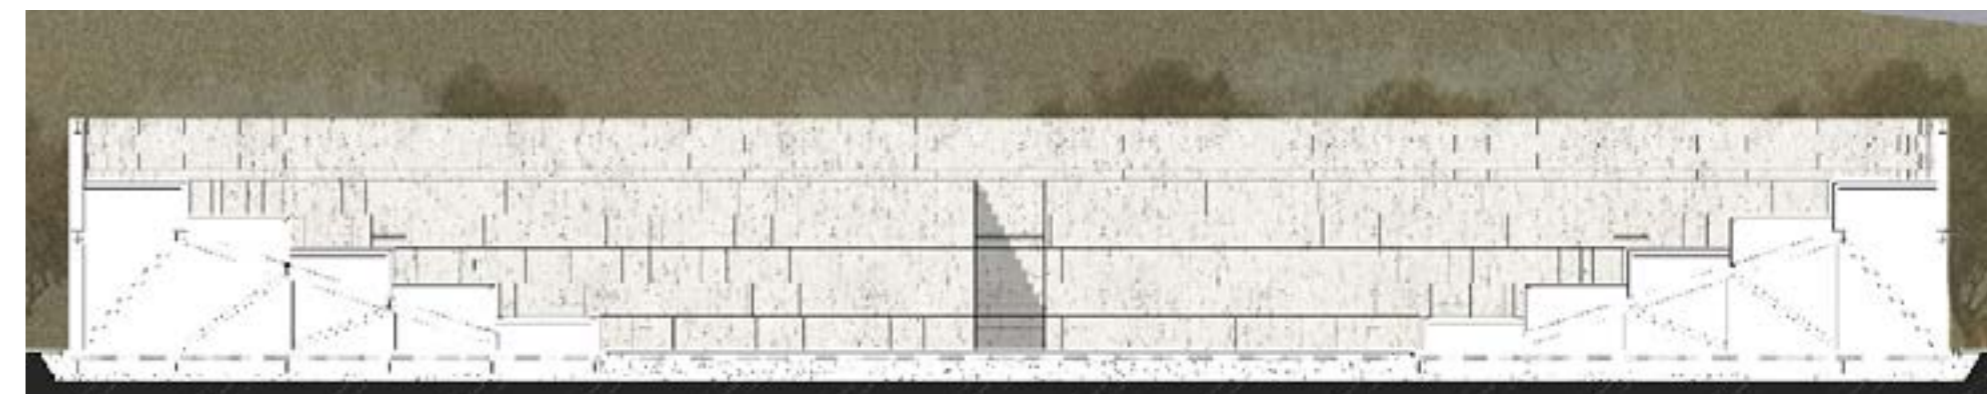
\_PROGETTO\_PLANIMETRIA DEL TEATRO
